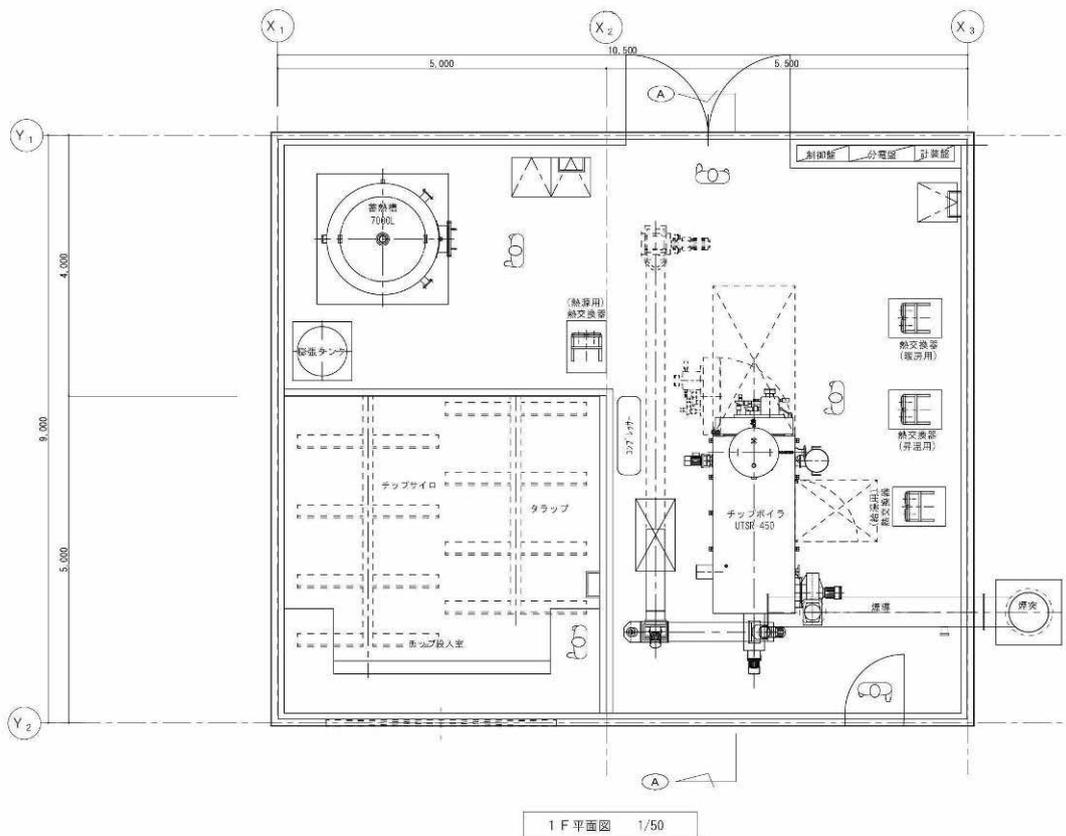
木質ボイラー 設備配置標準図 (1F 平面図)
